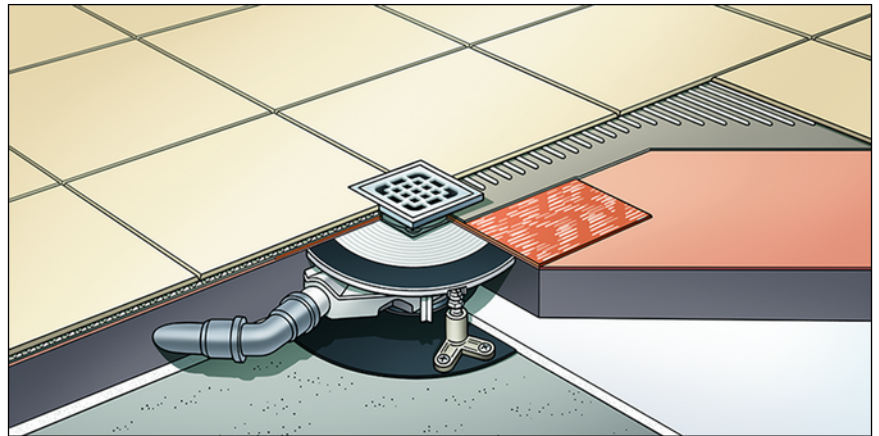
Esquema de un sistema de impermeabilización compuesto
